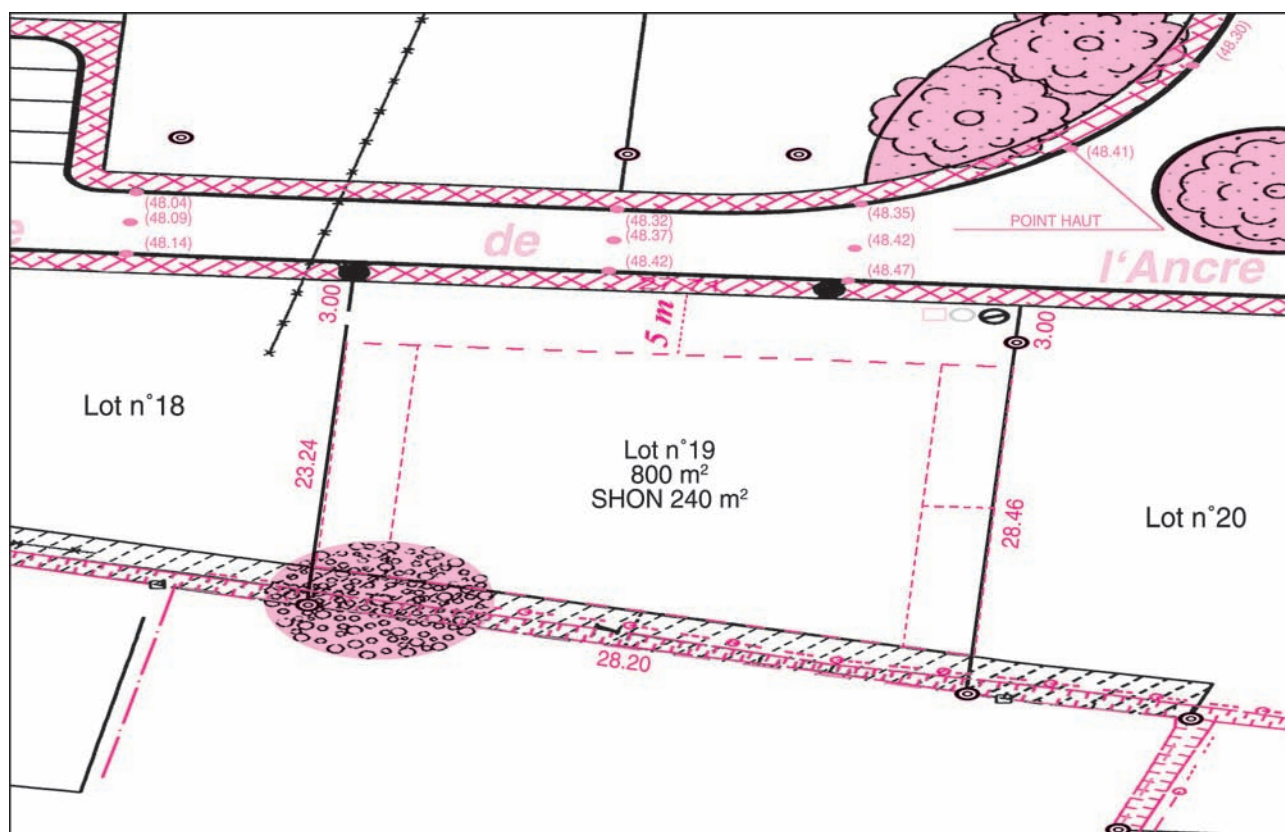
Plan parcellaire du lot n° 19 avec la zone constructible et les marges
